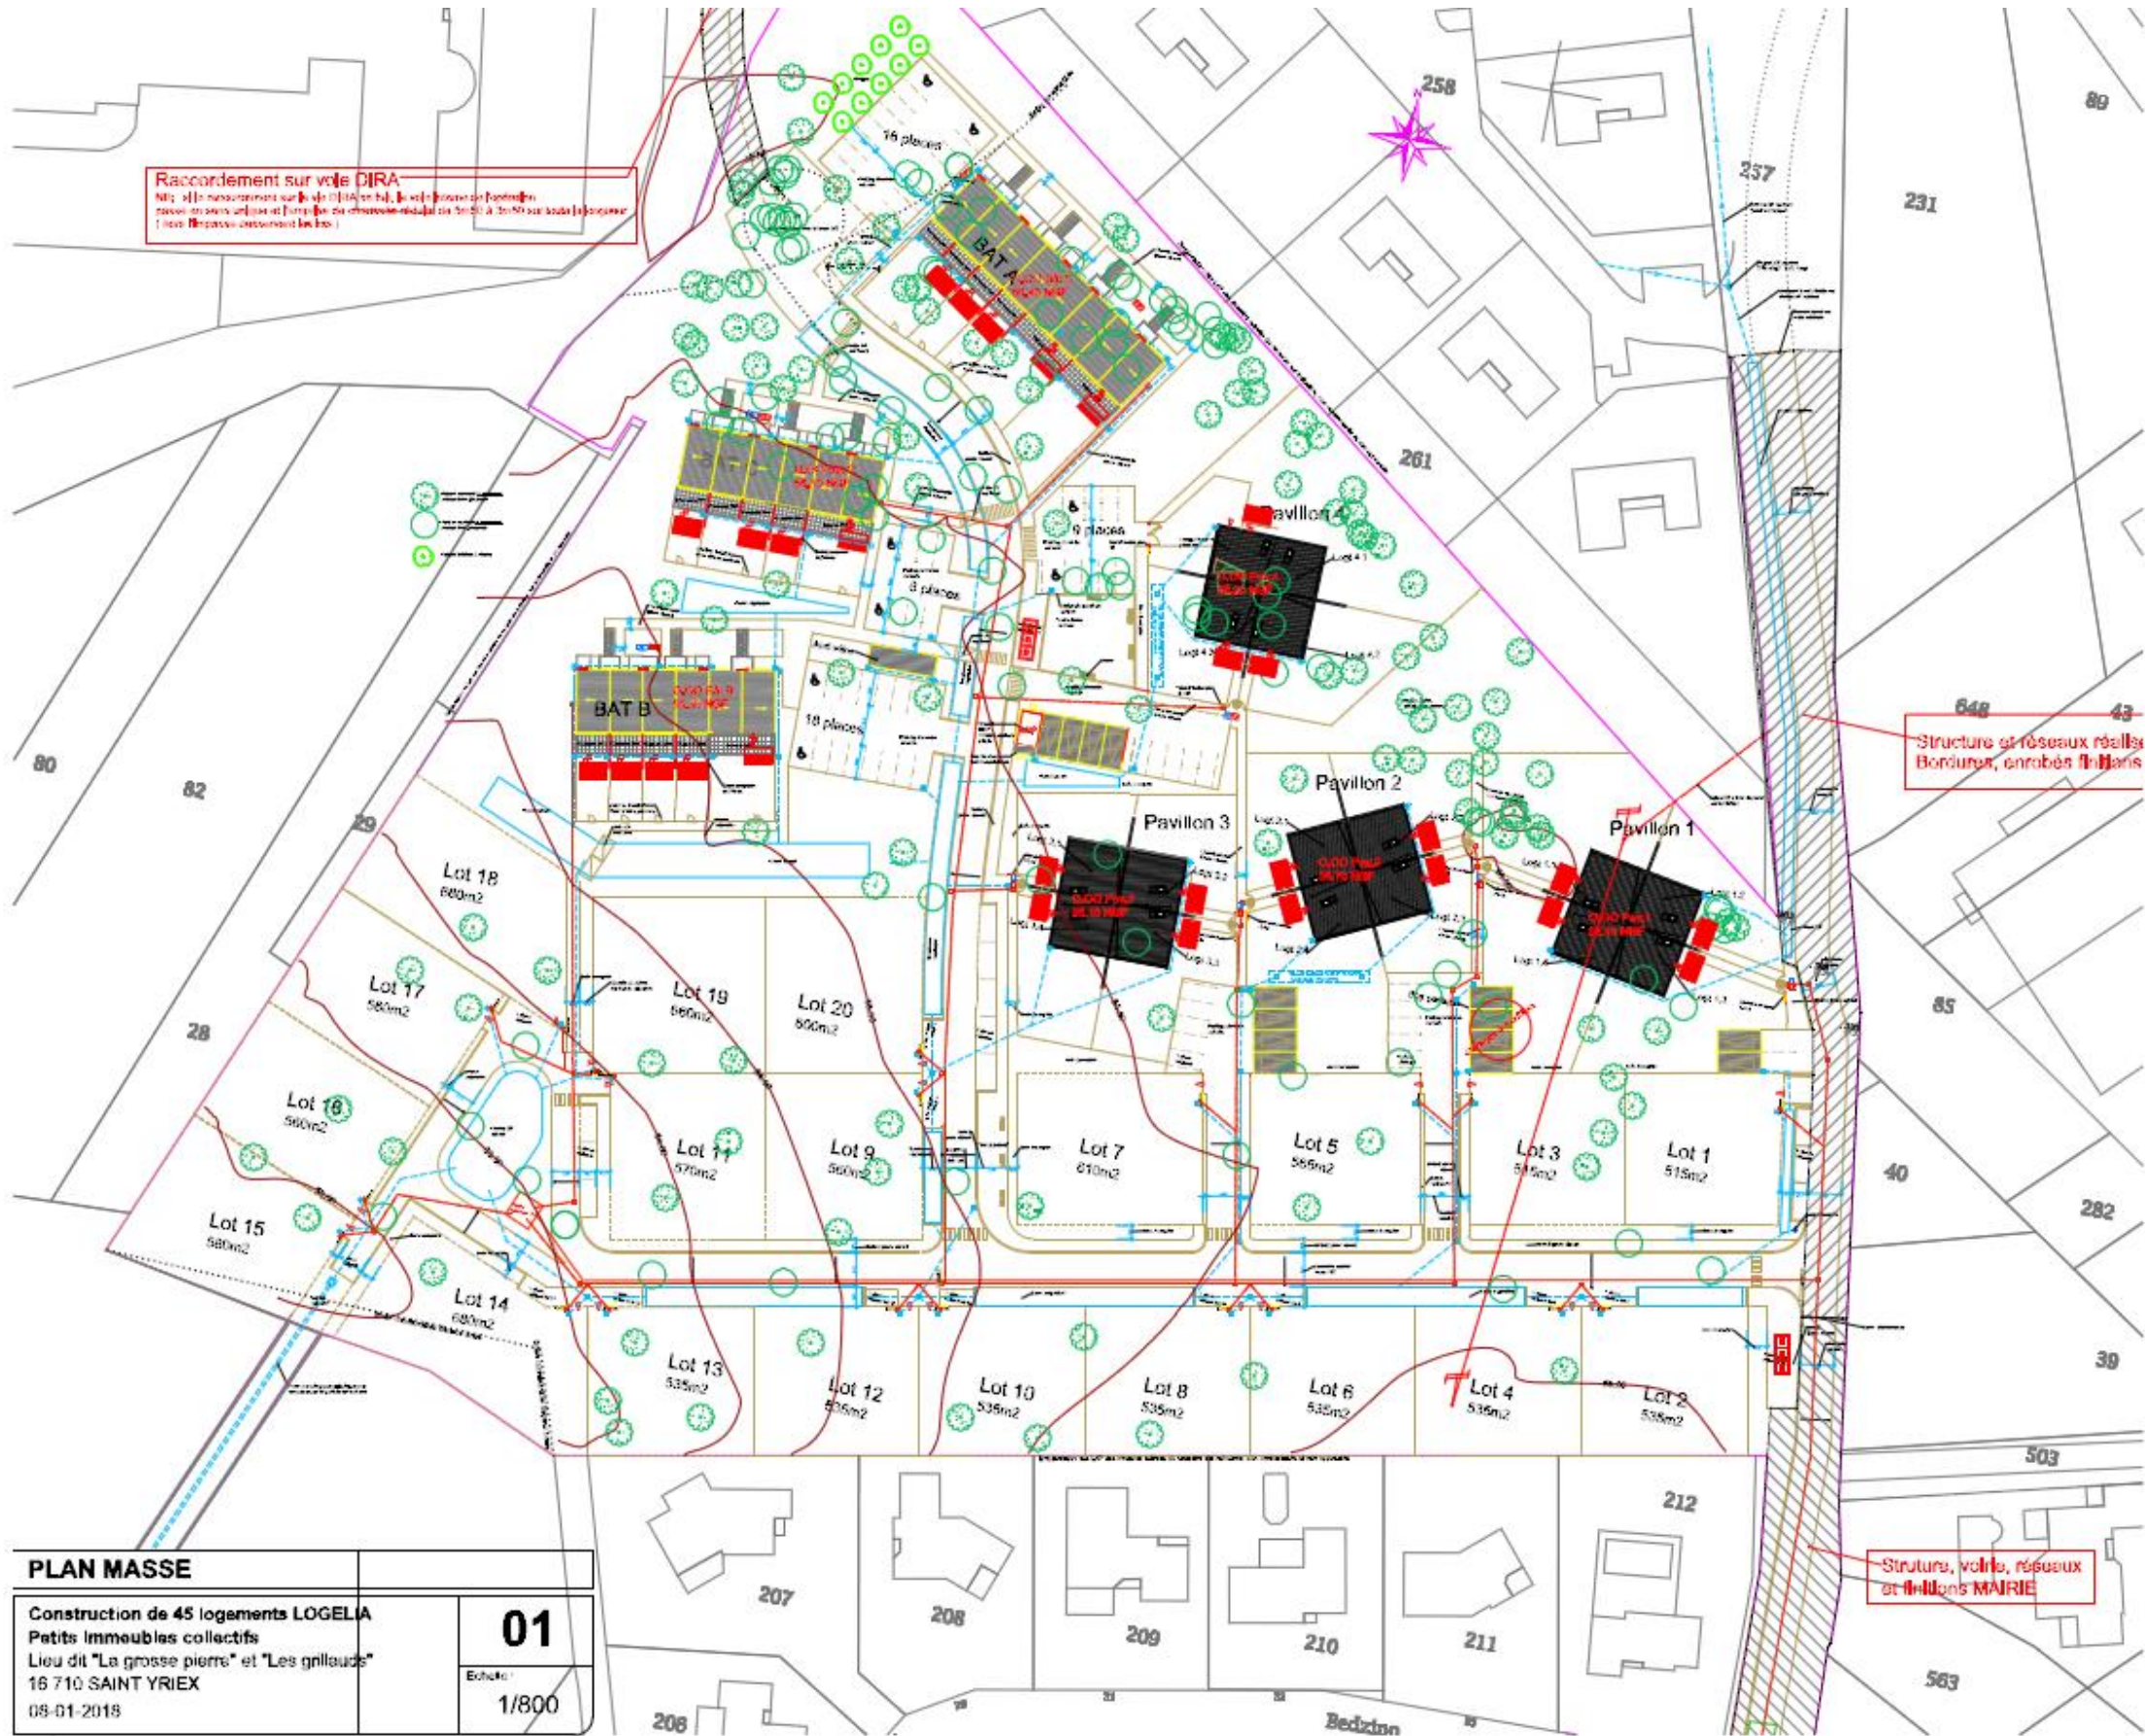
Plan de masse du projet (ABAQUE SARL)
